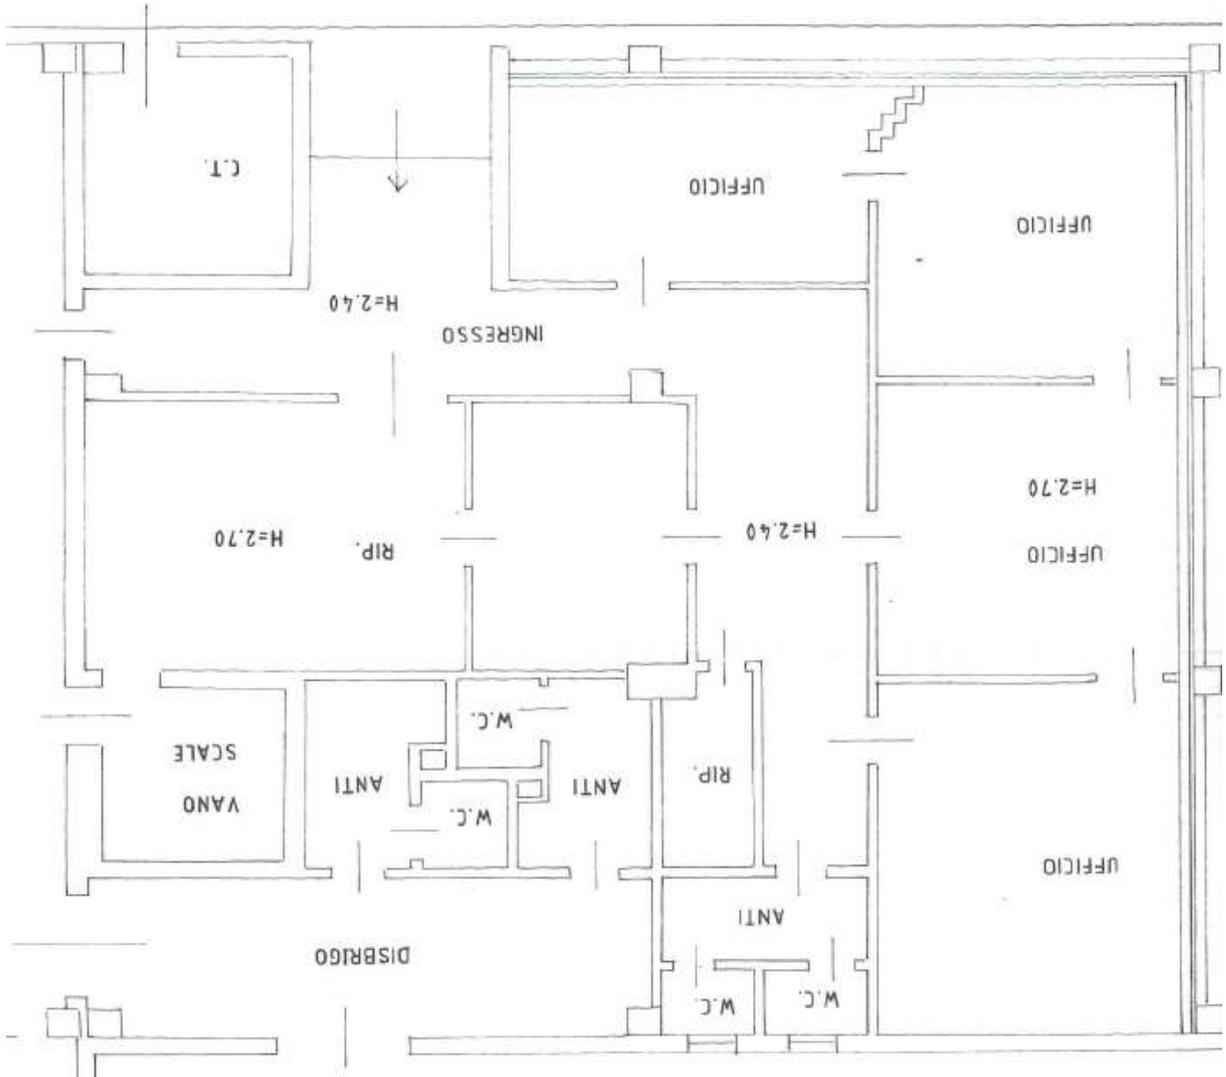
bis – planimetria Stato Autorizzato Concessione n. 95361 del 21/05/1997
